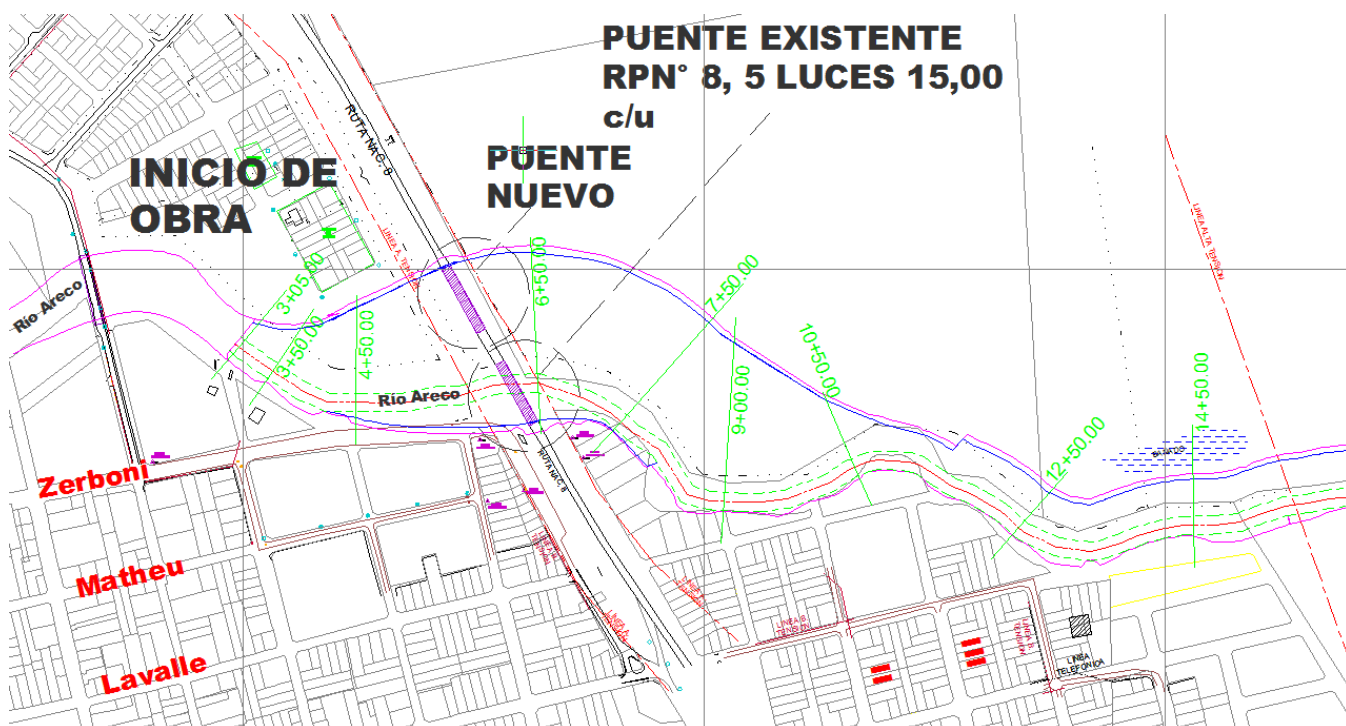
Planimetría de la intervención sobre la R.N. Nº 8 y sector urbano de San Antonio de Areco
